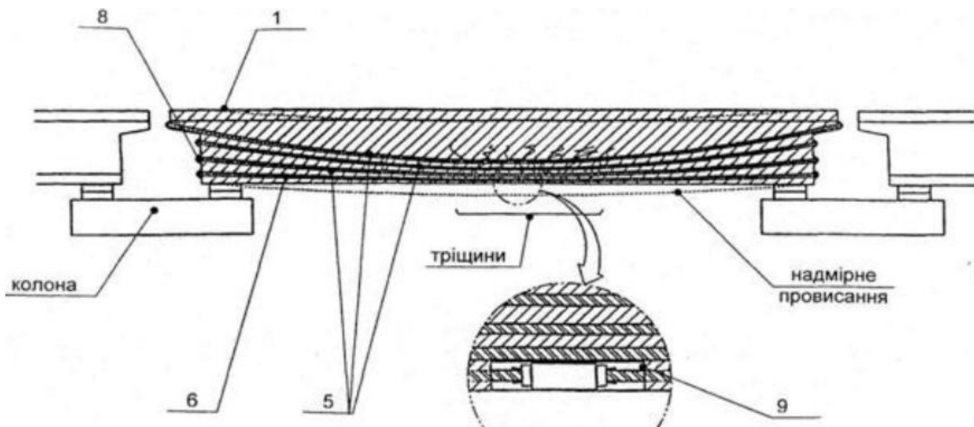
Попередньо напружена залізобетонна балка з регульованим напруженням: 1 – залізобетонна балка; 5 – сталеві троси, що натягуються під час виготовлення балки; 6 – сталеві троси, що натягуються під час експлуатації балки; 8 – кріпильний засіб сталевих тросів; 9 – вирізана частина для регулювання зусилля натягу сталевих тросів
